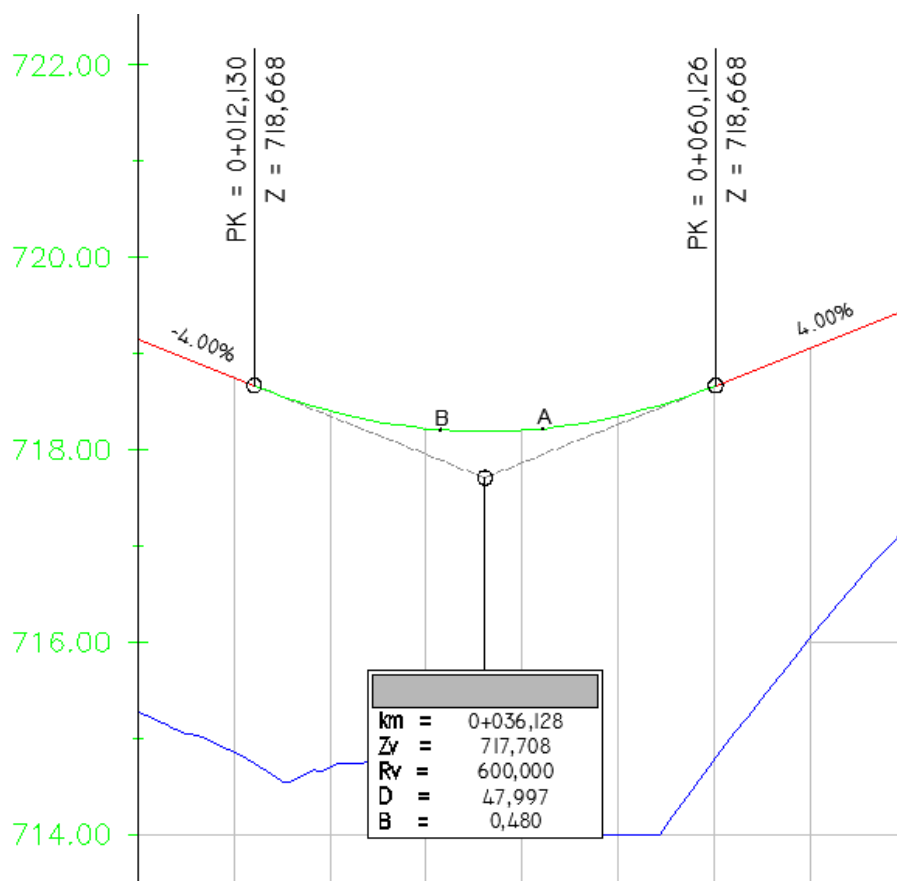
Perfil Longitudinal da Rotunda A – Intersecção com o ramo D
